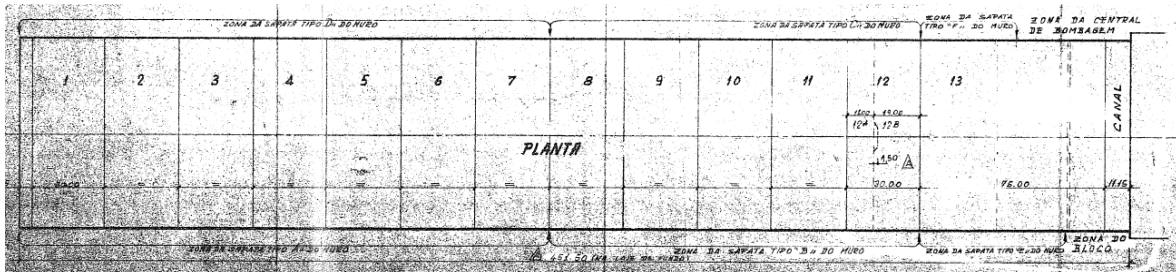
Divisão dos painéis da laje de fundo (Adaptado do projeto original do estaleiro)
